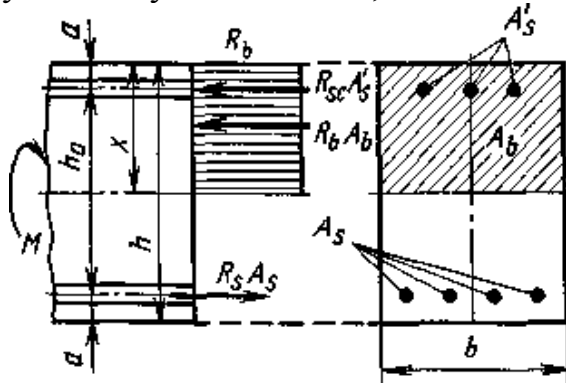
Розрахункова схема внутрішніх зусиль для елемента, що згинається, з подвійною арматурою
